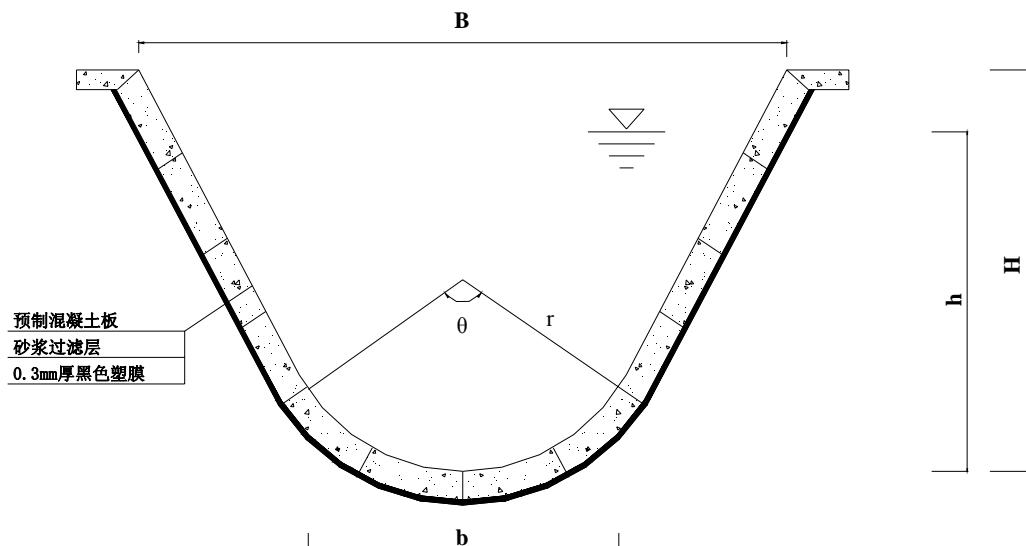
内蒙古河套灌区预制混凝土弧底梯形衬砌结构形式
